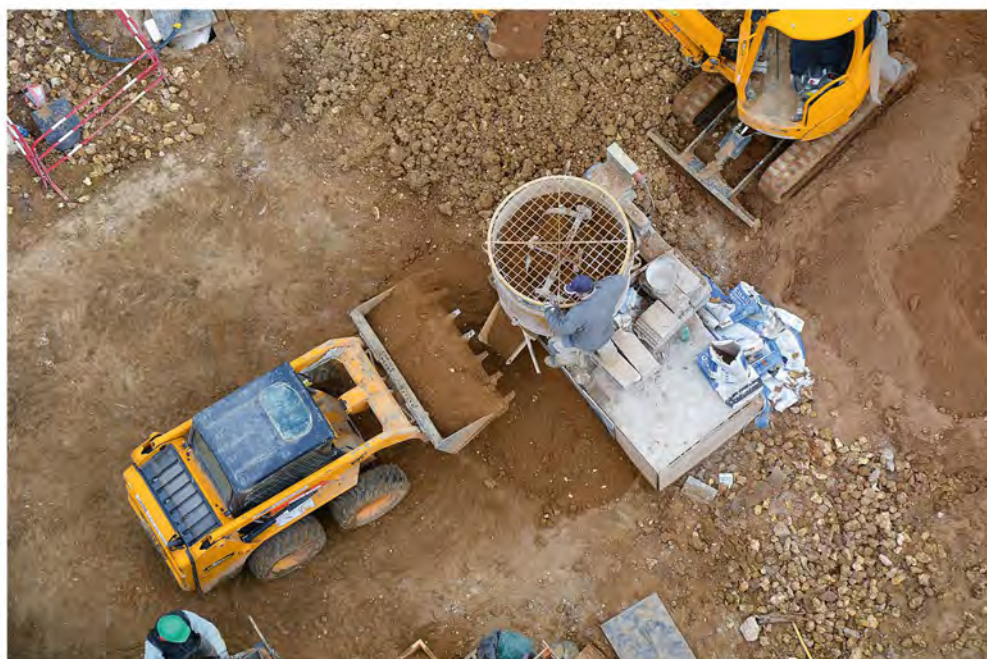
Malaxage mécanique avec malaxeur planétaire
